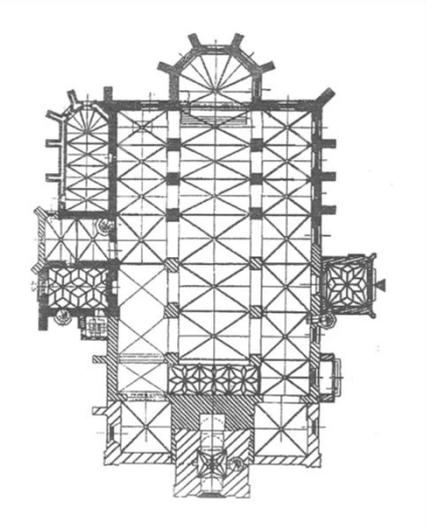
Levoča, Jakobskirche, Grundriss, 1332-42 und 1370-92
